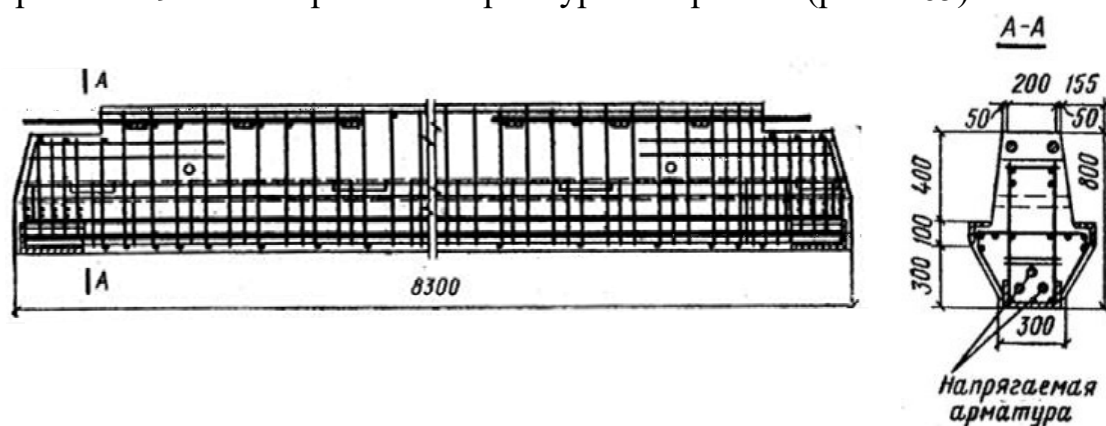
Армирование ригеля поперечной рамы пролетом 9 м
